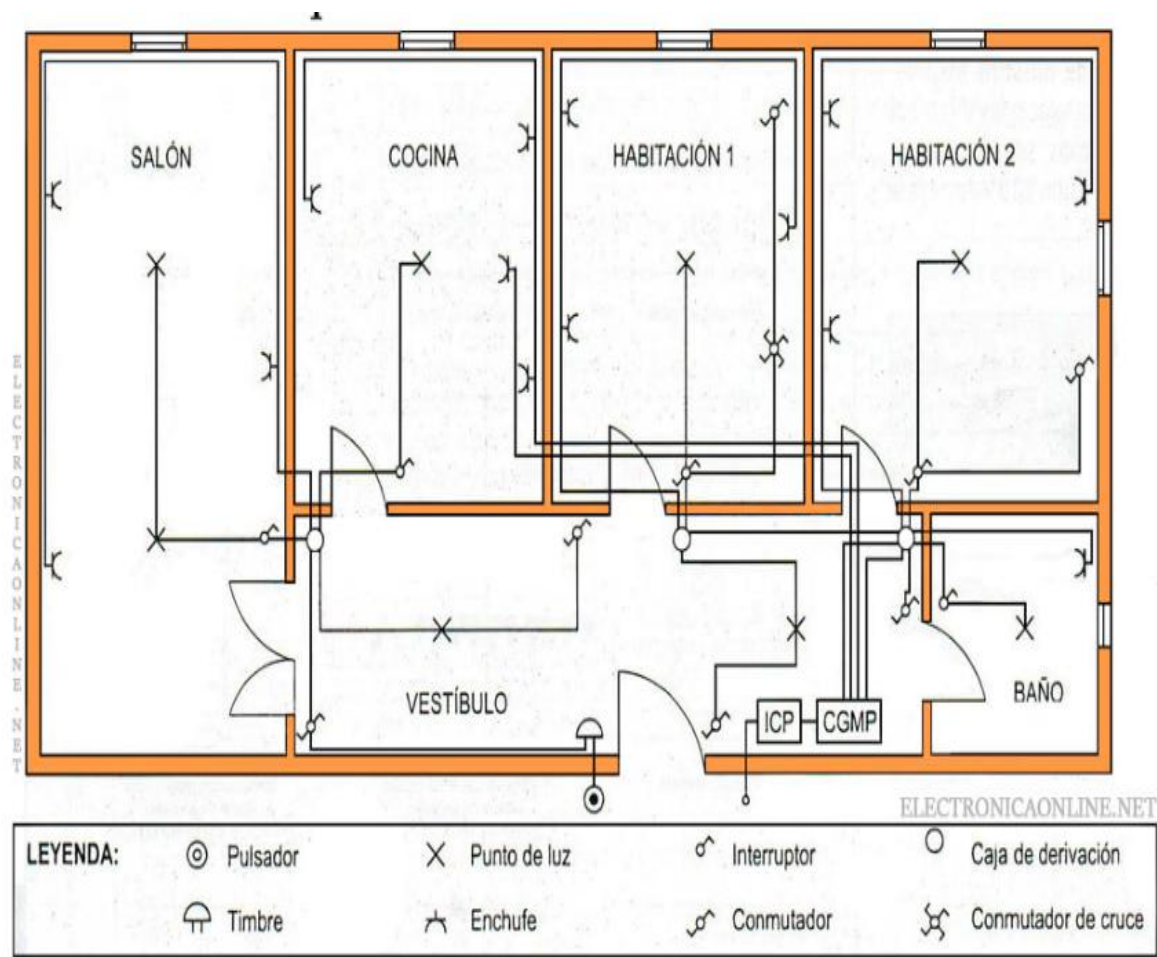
Plano eléctrico esquemático de una vivienda.⁹⁸
